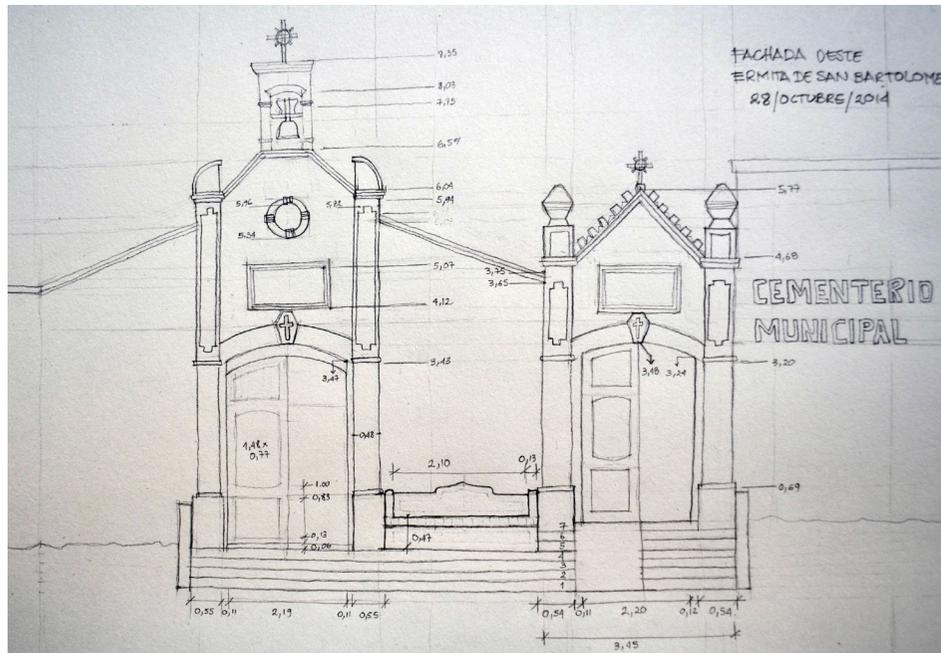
Croquis de la fachada Oeste de la Ermita de San Bartolomé.
